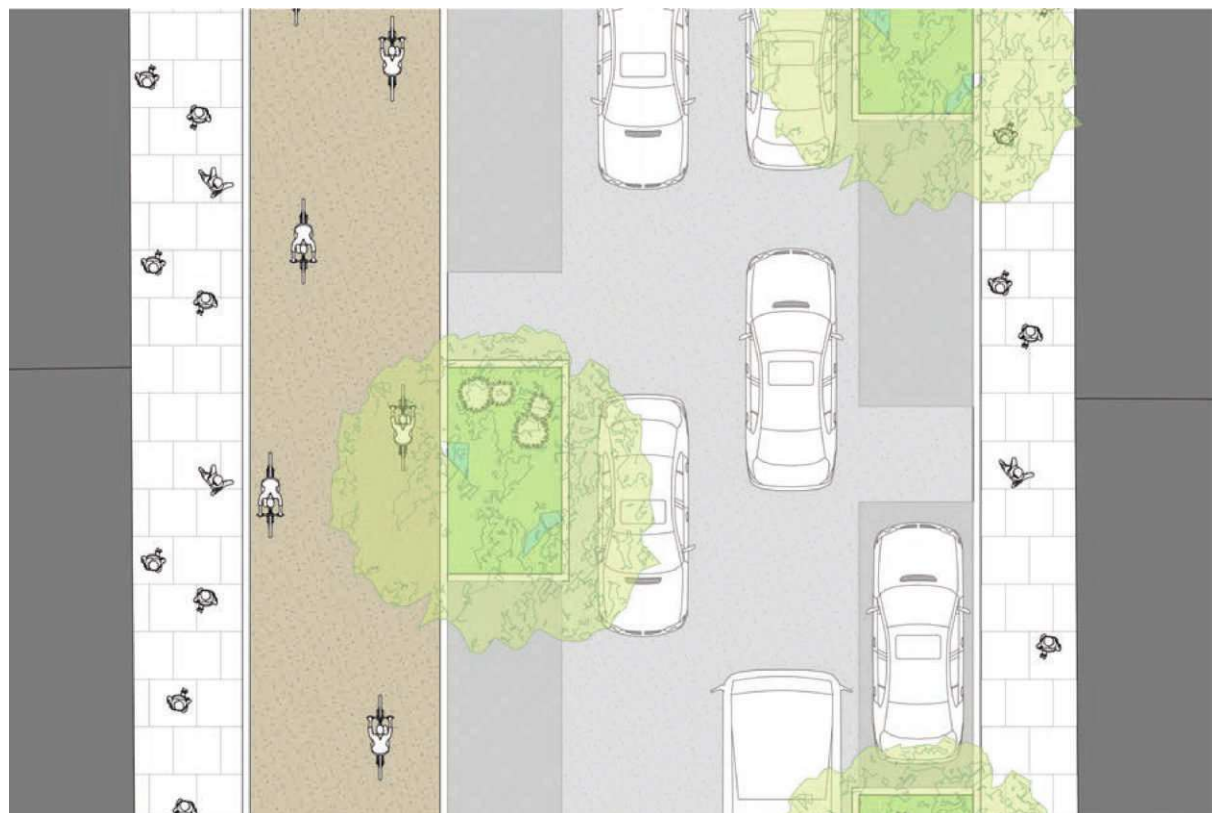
Grundrissausschnitt Hauptstraße, eigene Darstellung
